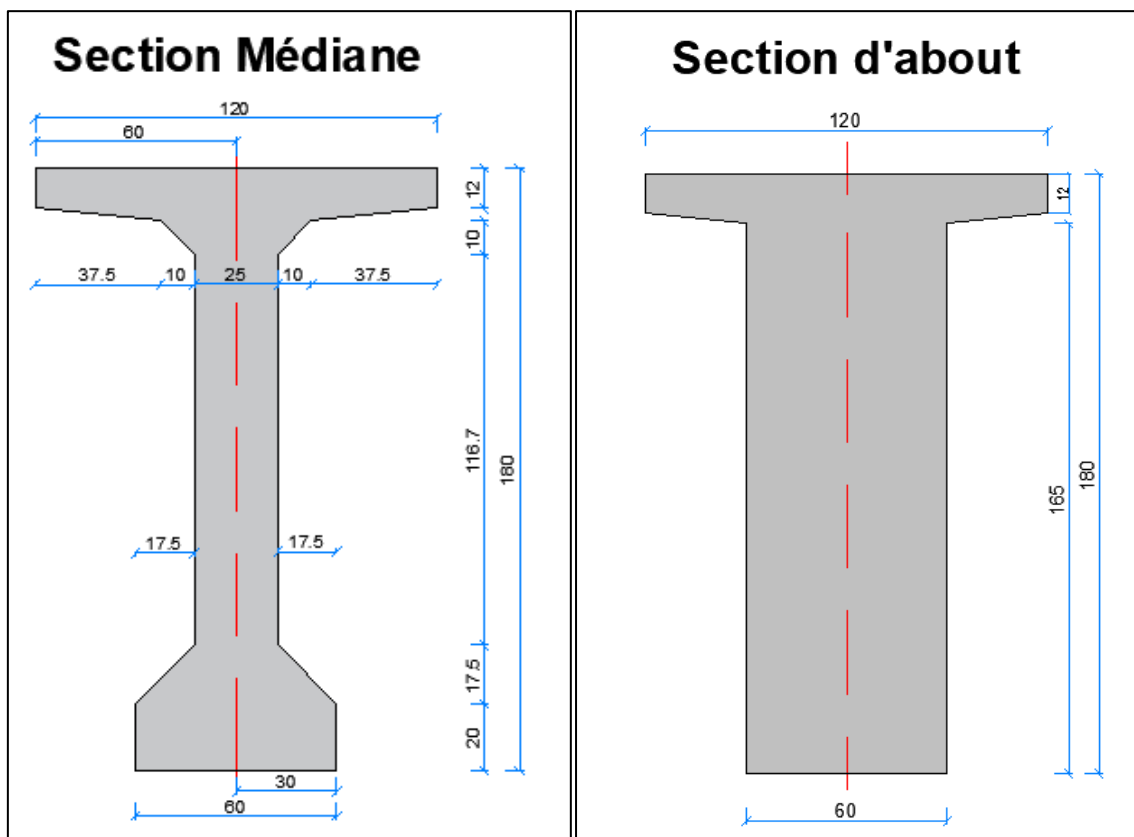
Les sections de la poutre VARIANTE 01
